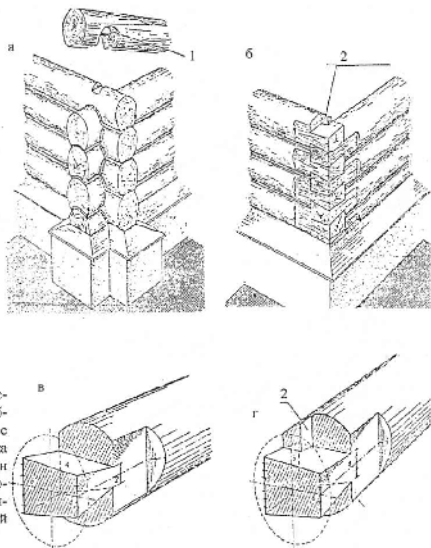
Угловые соединения бревен сруба: а, б – общий вид сруба с врубкой с остатком (а) и без остатка (б); в, г – детали углов стен рубленых без остатка; простая лапа (в) и лапа с коренным шипом (г); 1 – потайной шип; 2 – коренной шип
